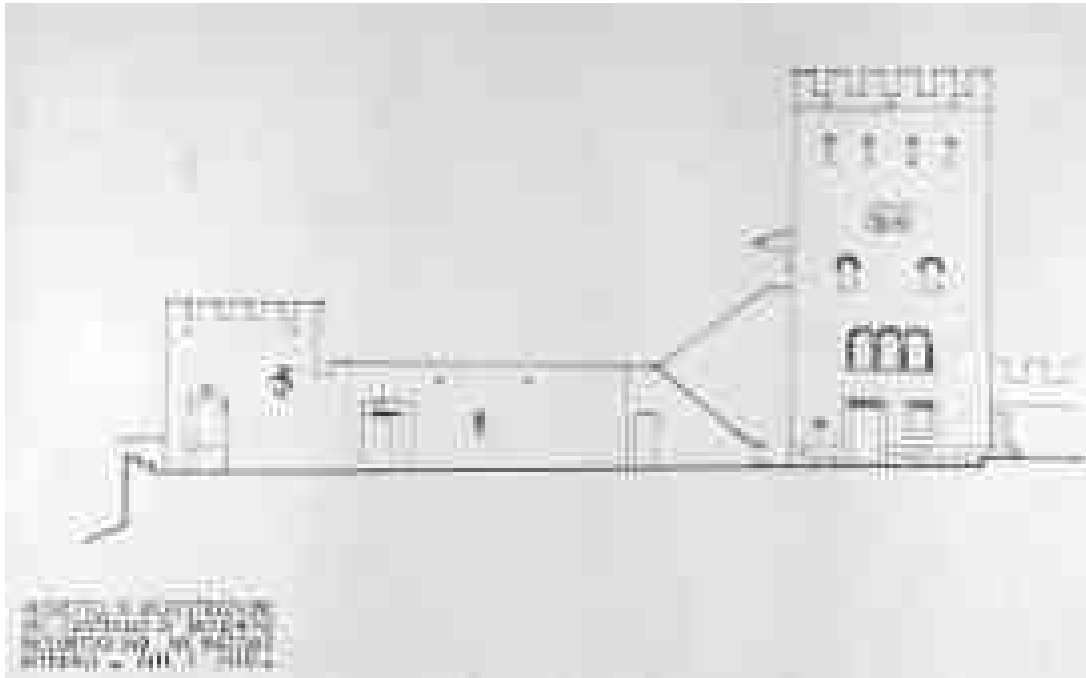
Iginò Epicòco. Butrinto, castello veneziano. Progetto di ricostruzione. Prospetto sul piazzale interno, Progetto A (cortesia famiglia Taddei).
